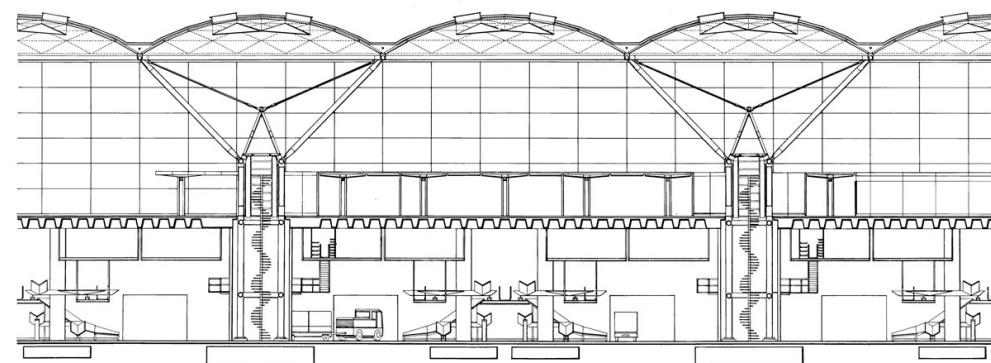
Sección de las dos plantas y el sistema estructural
